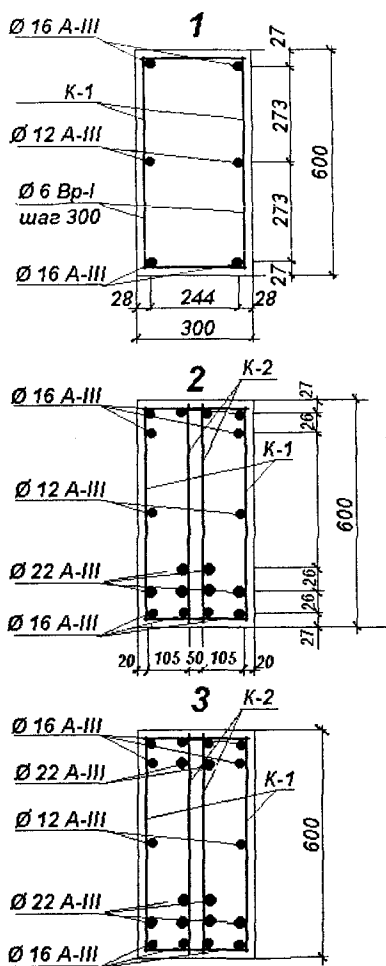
Армирование верхнего пояса арки (сечения 1,2,3)
